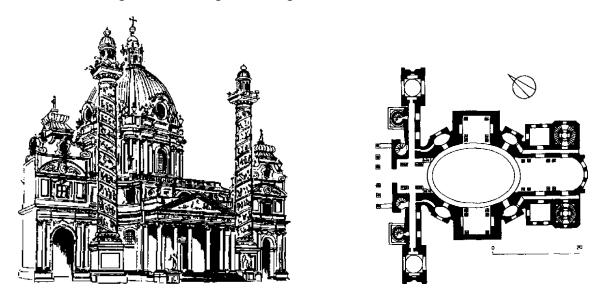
Вена. Церковь Св. Карла Борромео (1716–1733). Фасад. План
